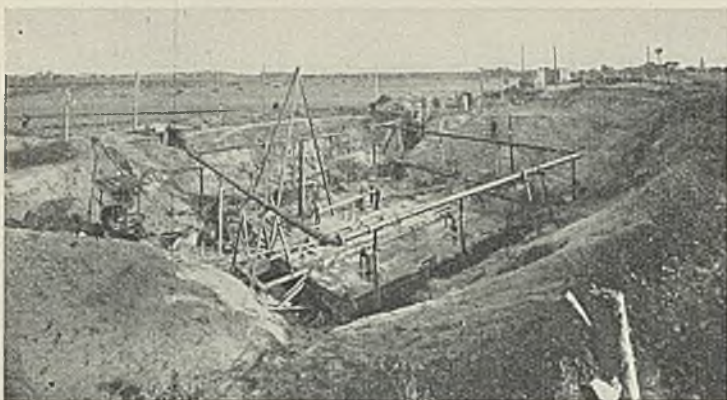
Baugrube nach Hochwassereinbruch etwa 6,30 m tief ausgeschachtet, 4,80 m Grundwasser abgesenkt.
